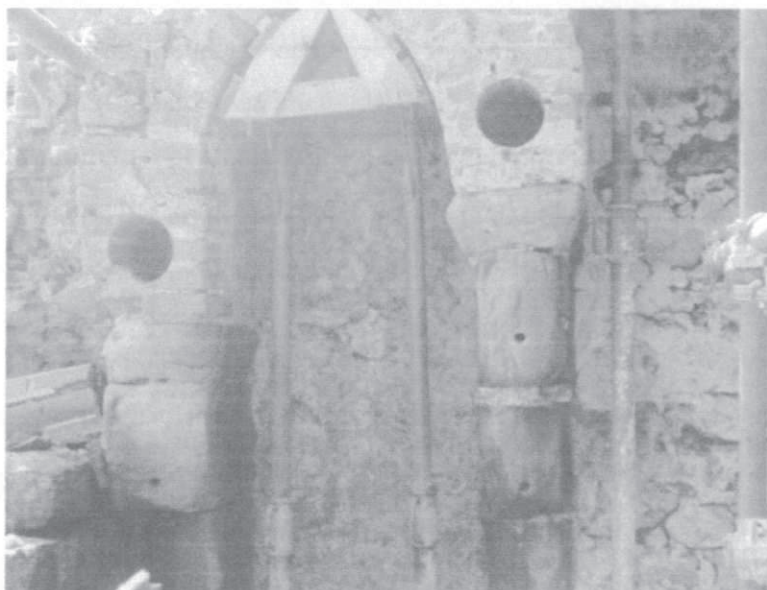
Beccatelli del camminamento: fori per la cucitura delle mensole e carotaggi per l'inserimento dei profilati HEA inox
